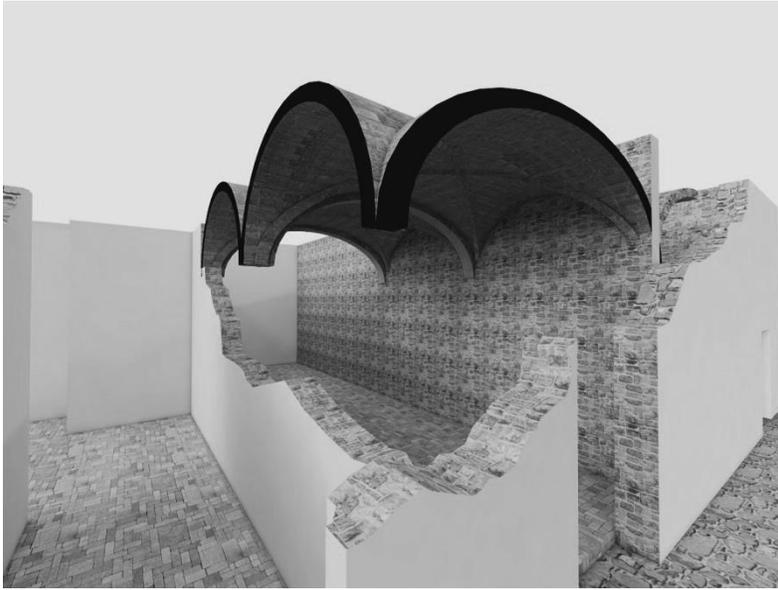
Sección del plano ubicación de elementos arquitectónicos. Zapatería Gottico.
